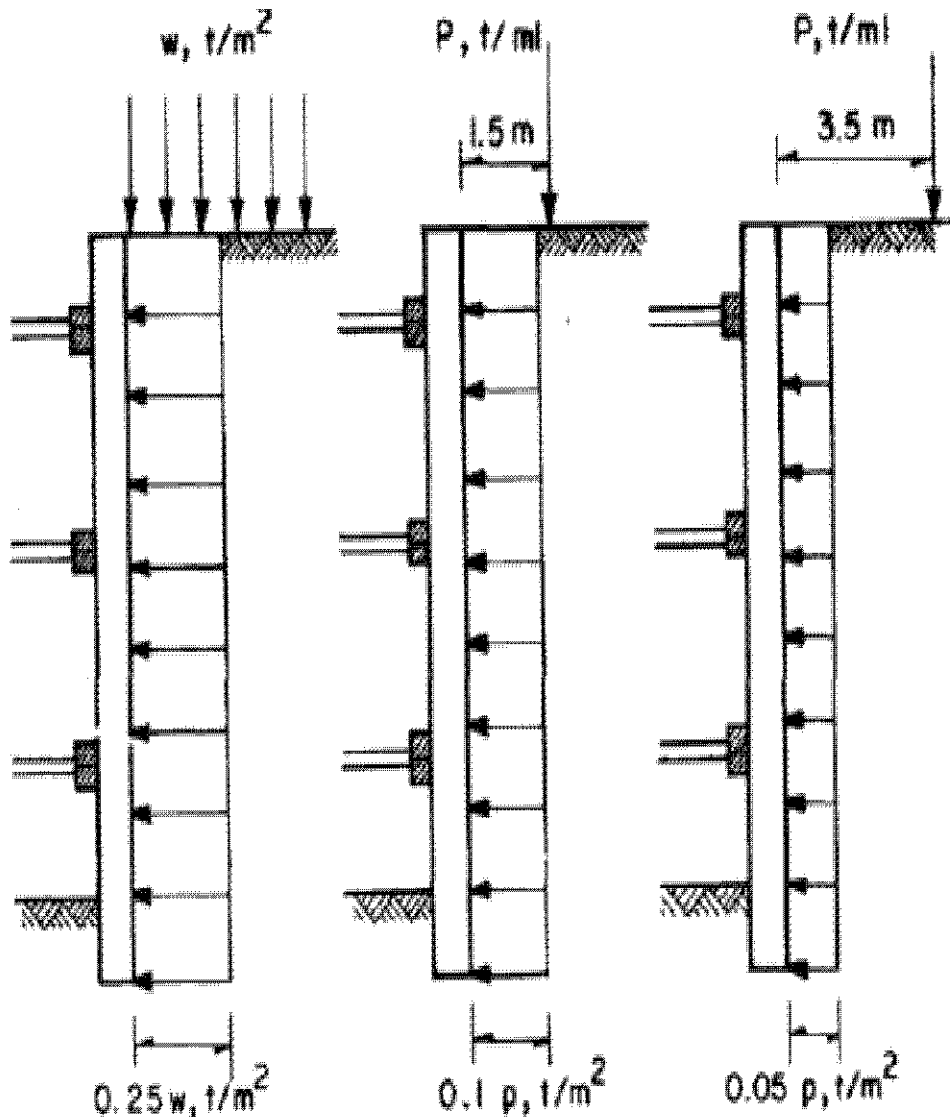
Diagramas de empujes horizontales debidos a sobrecargas superficiales (covitur)
